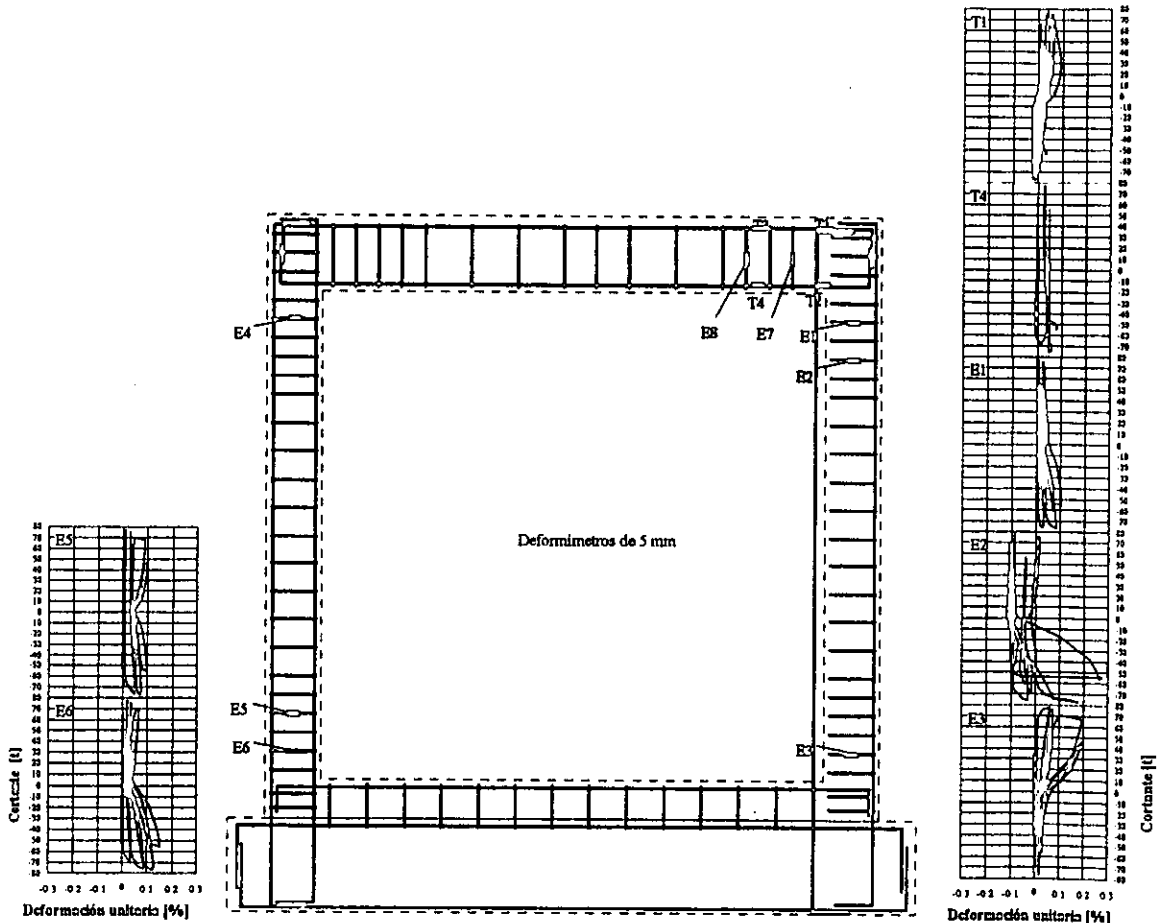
Deformímetros ubicados en el acero transversal de trabe y columnas
